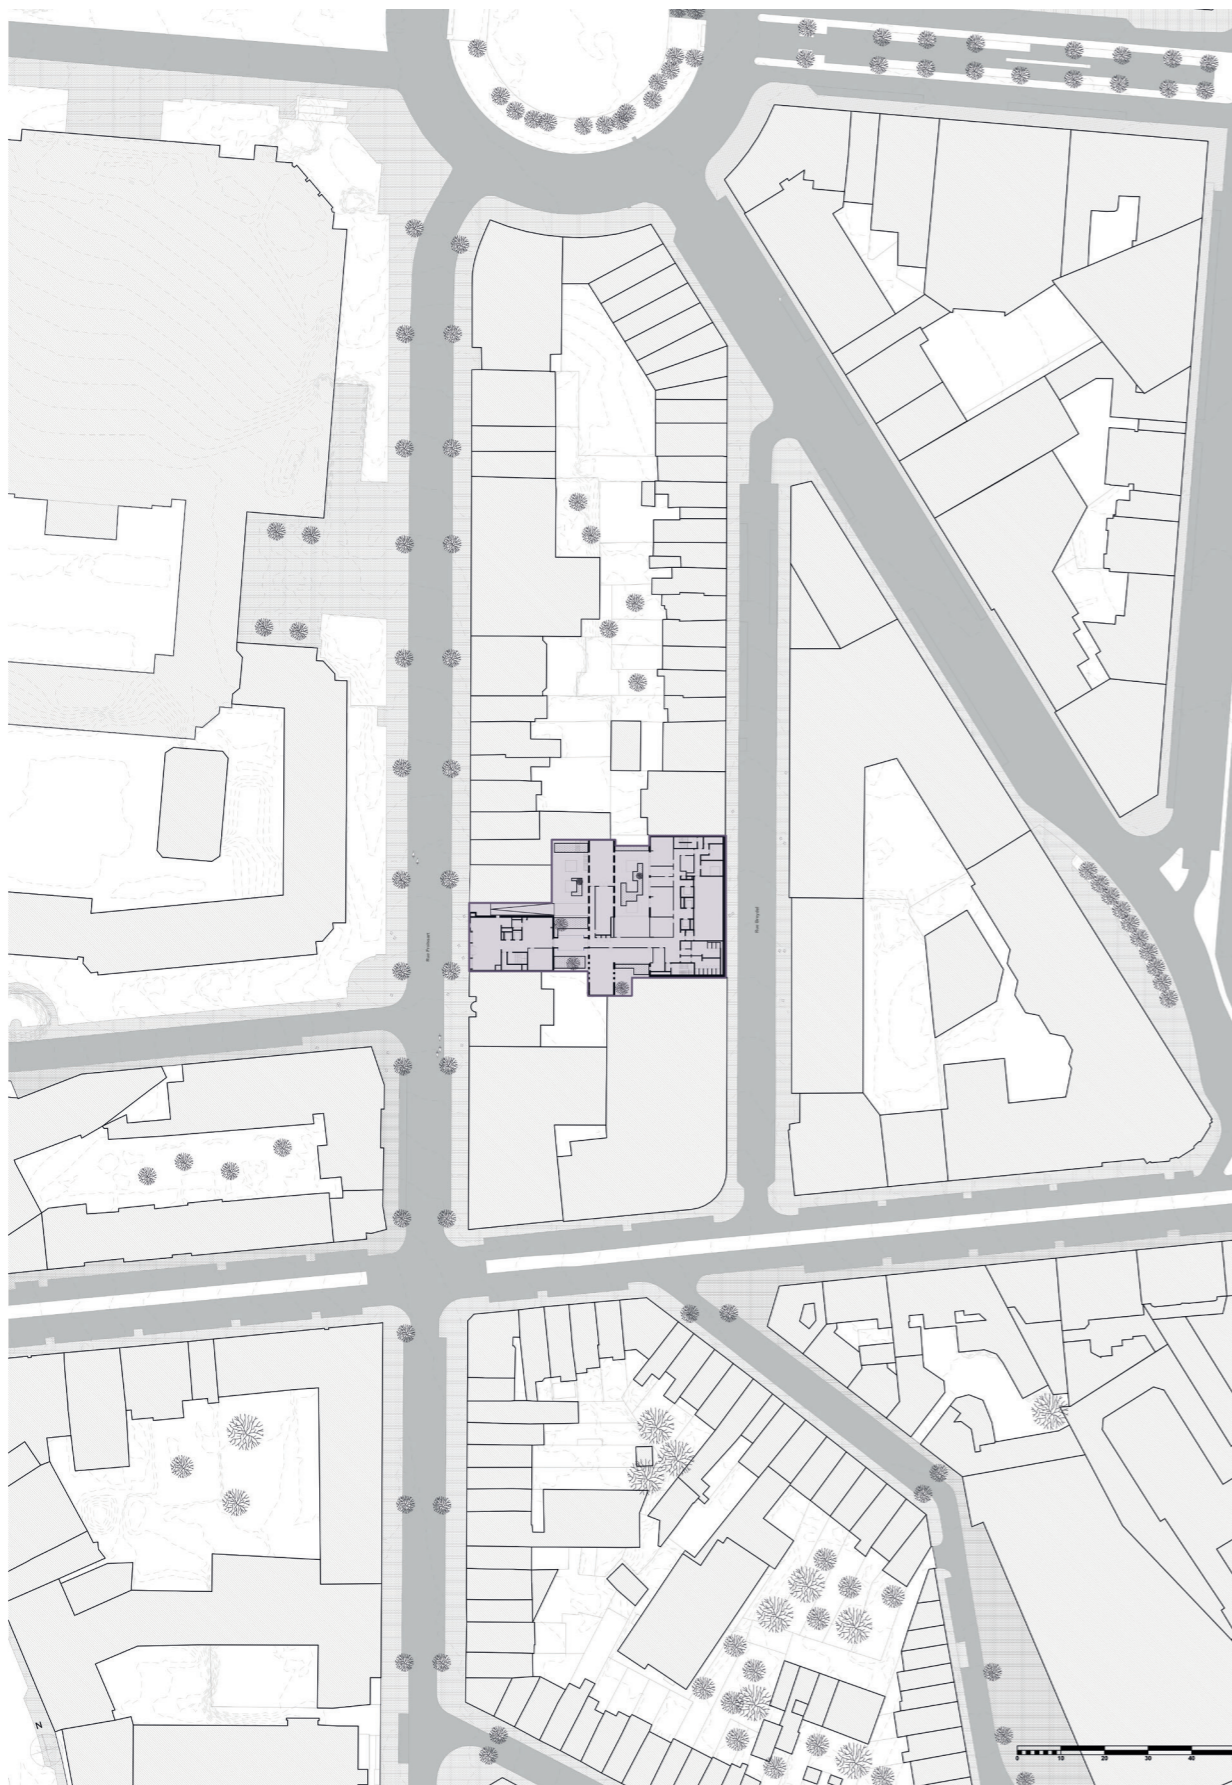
Plan d'implantation (réalisée par l'autrice, 2025)
